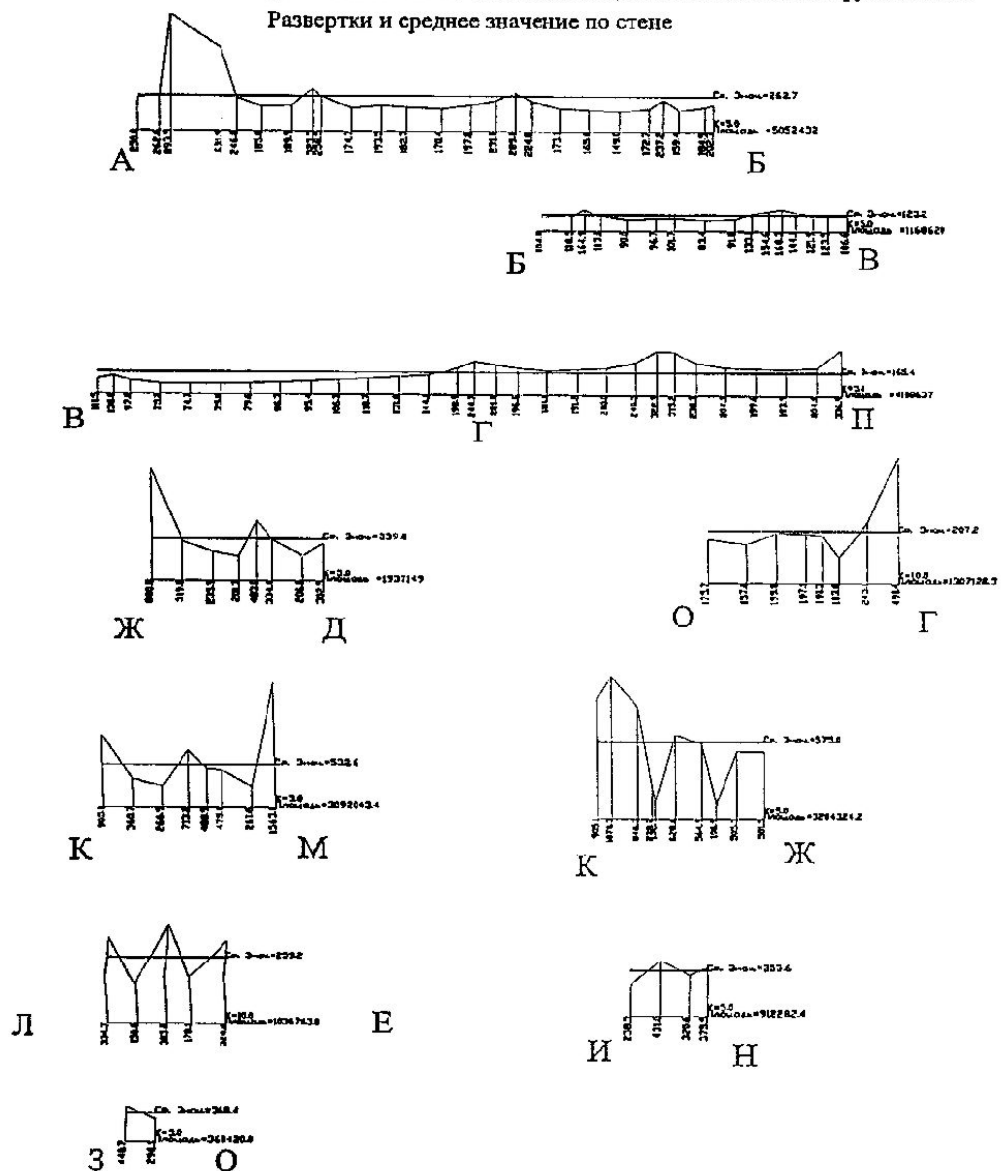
Нагрузки в уровне верха фундаментной плиты здания по Ермолаевскому пер., 15/44.
